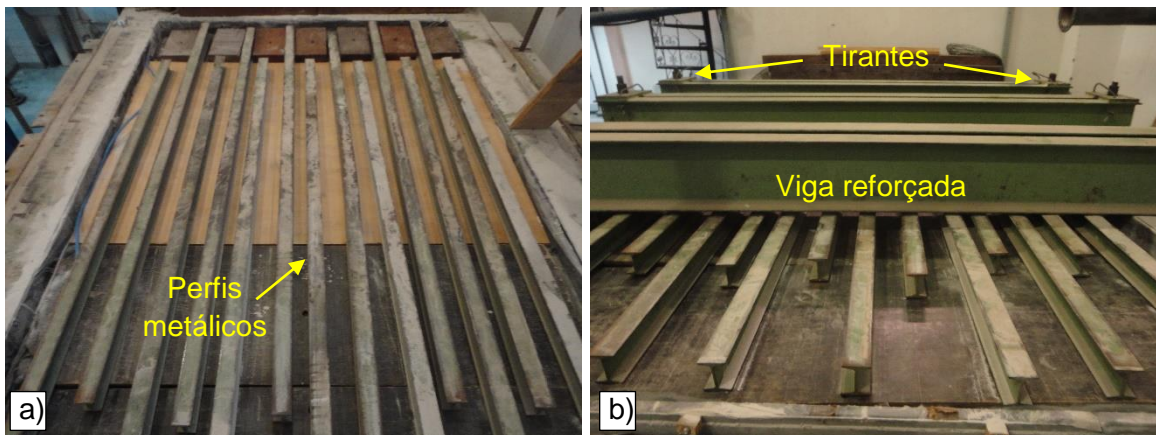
a) Perfis estruturais metálicos, colocados acima das placas de madeira de modo a compor uma plataforma rígida; b) vigas metálicas presas a tirantes para fixação do sistema de reação.
